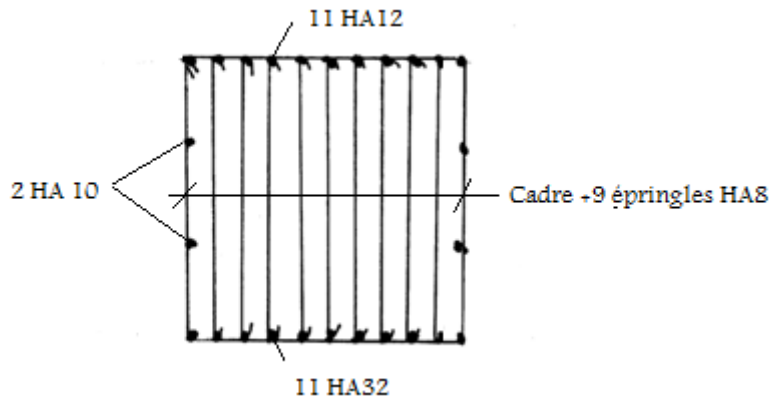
Coupe transversale du ferrailage de la semelle.
